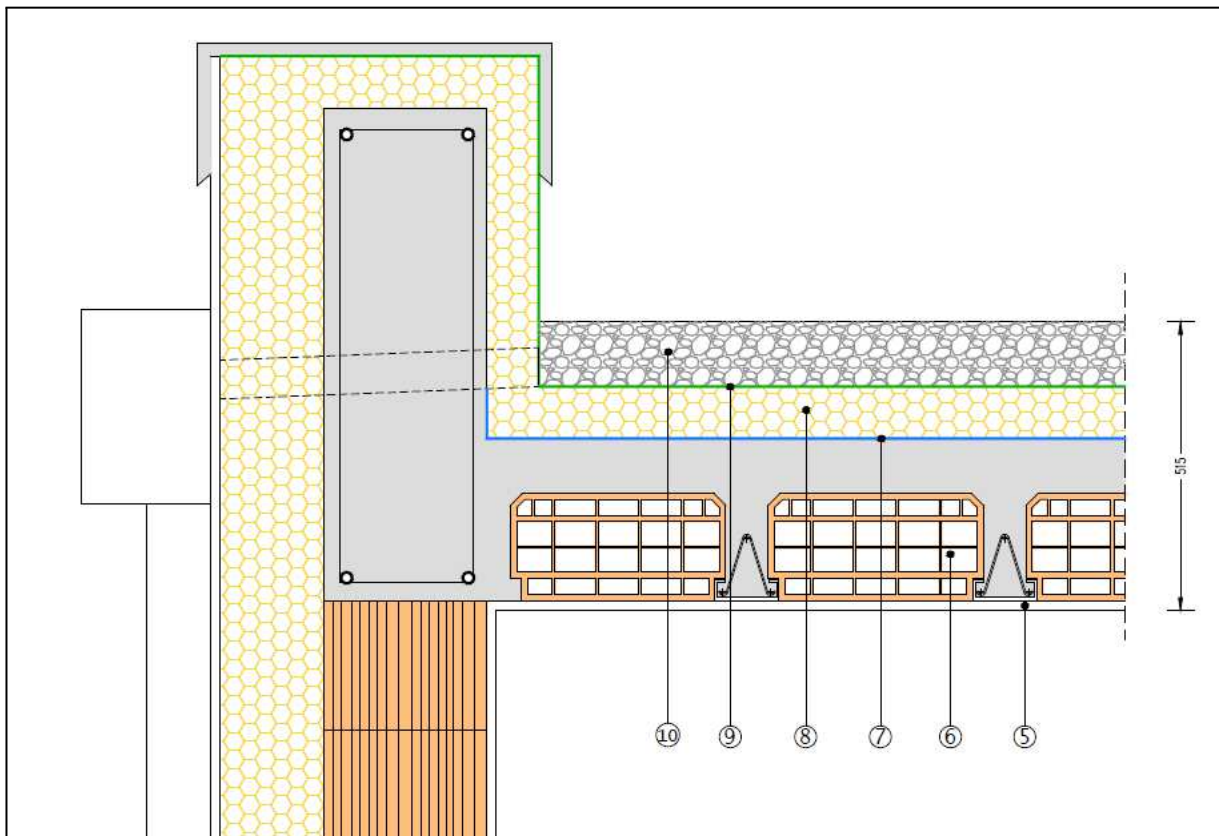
Sistema a telaio in C.A. nodo parete perimetrale-solaio copertura
